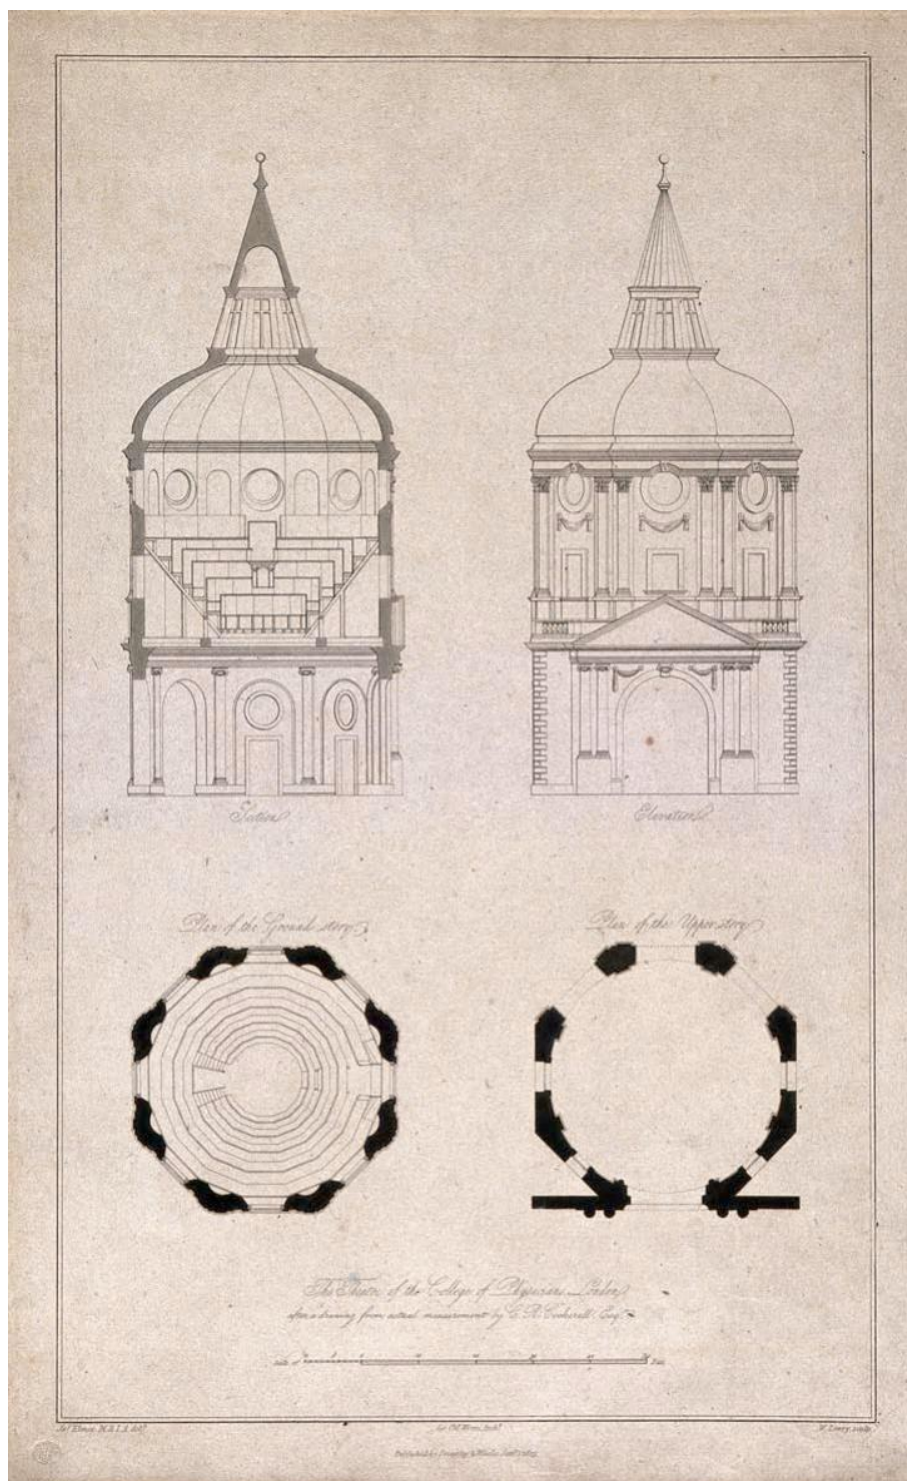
Teatro anatomico di Londra, sezione, prospetto e pianta
